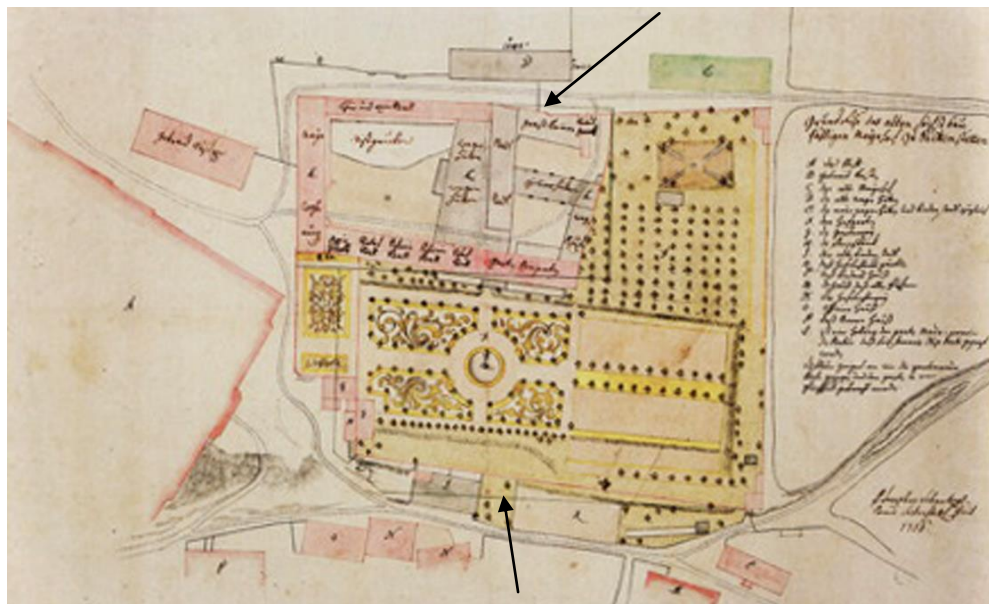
1756 „Grundriss des alten höchst baufälligen Mayrhof zu Seitenstetten“
